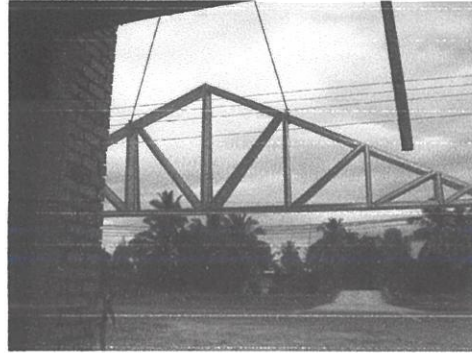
&f: Sambungan wall plate pada RC beam
